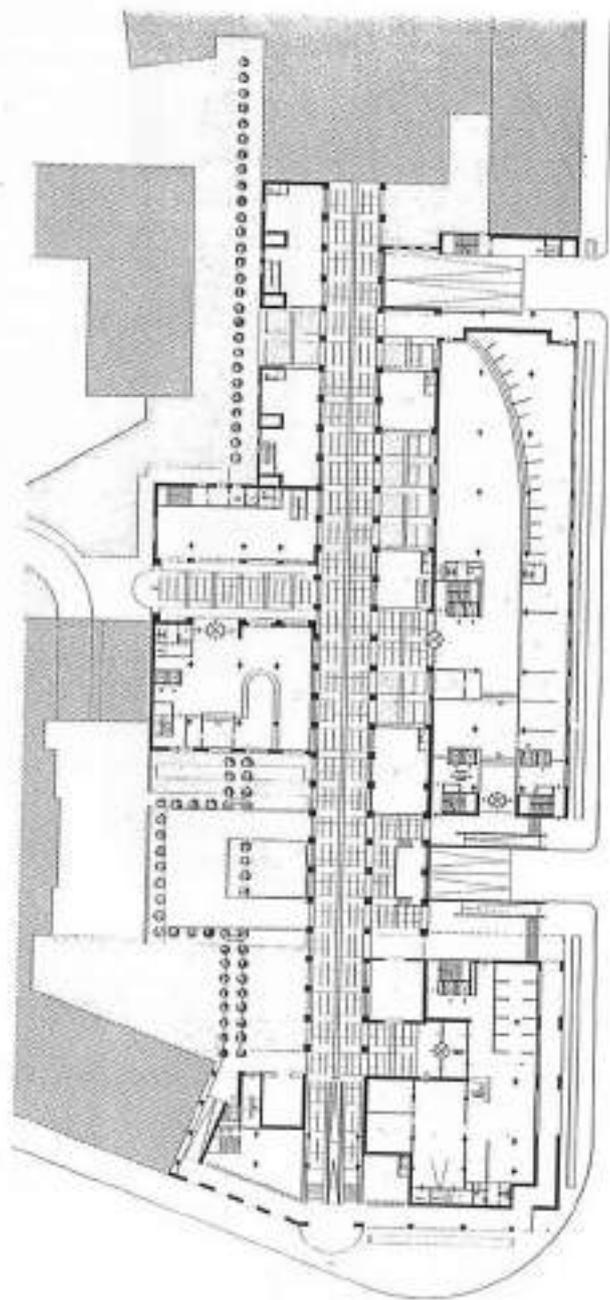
Riqualficazione area Via Alto Adige e piazza Verdi a Bolzano: pianta piano terreno.
